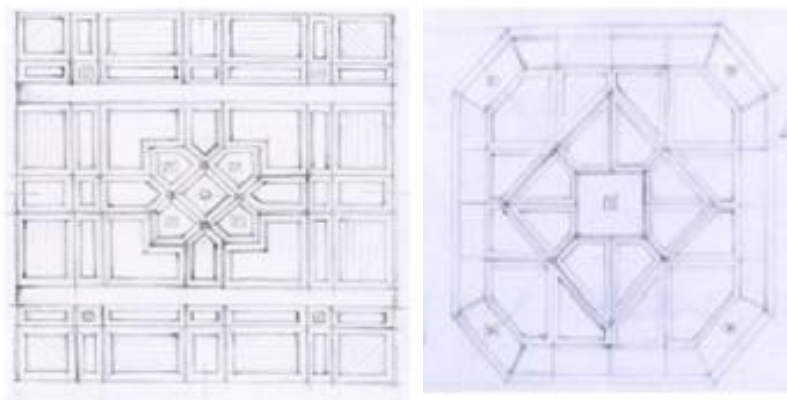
Planta de Tetos, desenhos da Mónica Romãozinho
